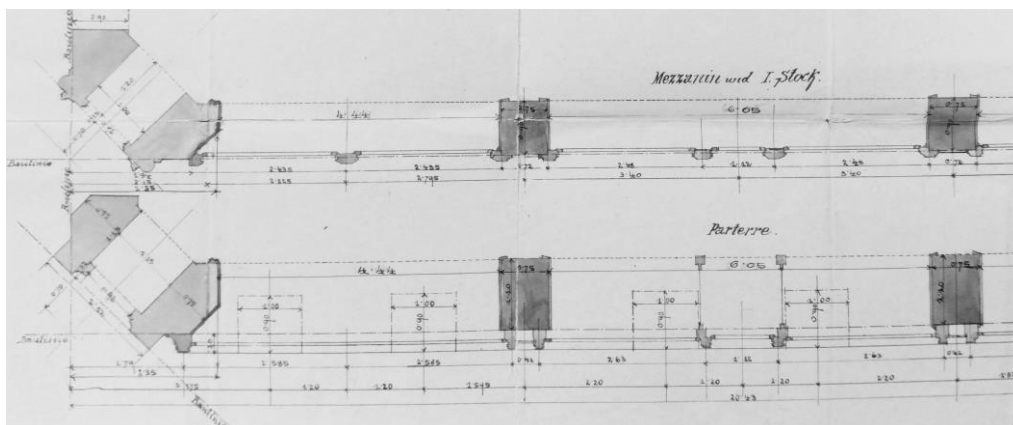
Fellner&Helmer, Rothberger, Grundriss Fassade, Wien, 1886
